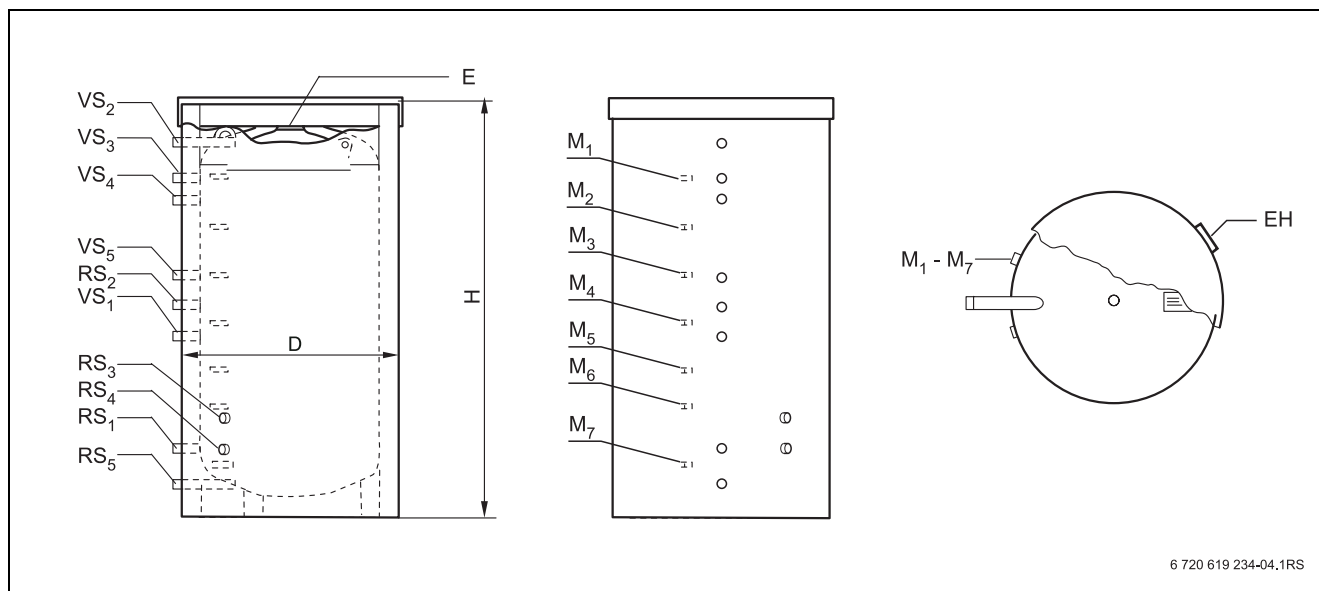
Abmessungen und Anschlüsse (Maße in mm)
